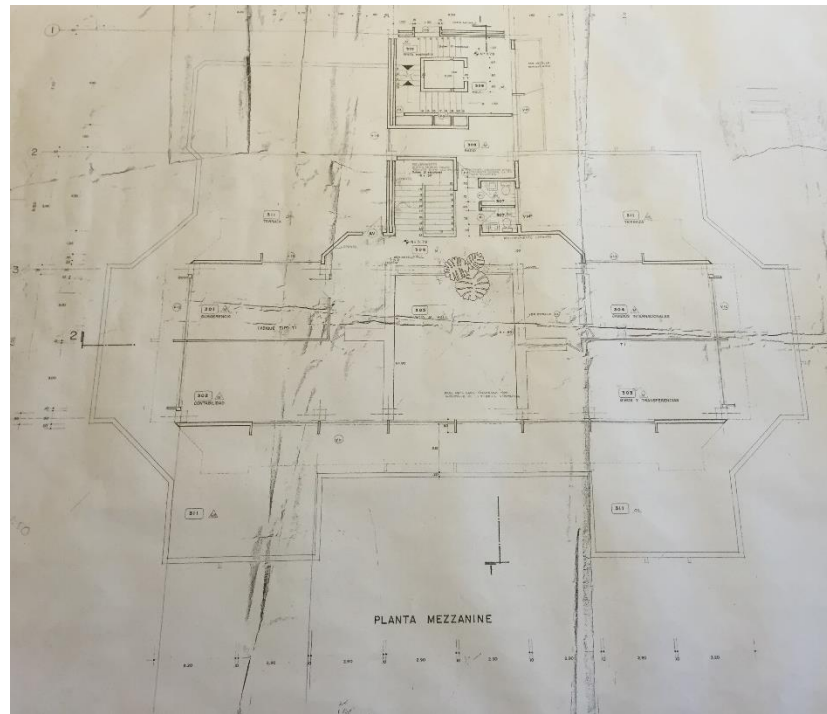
, Planta Mezzanine, edificio BNC CENTRAL, Jipijapa, Manta
